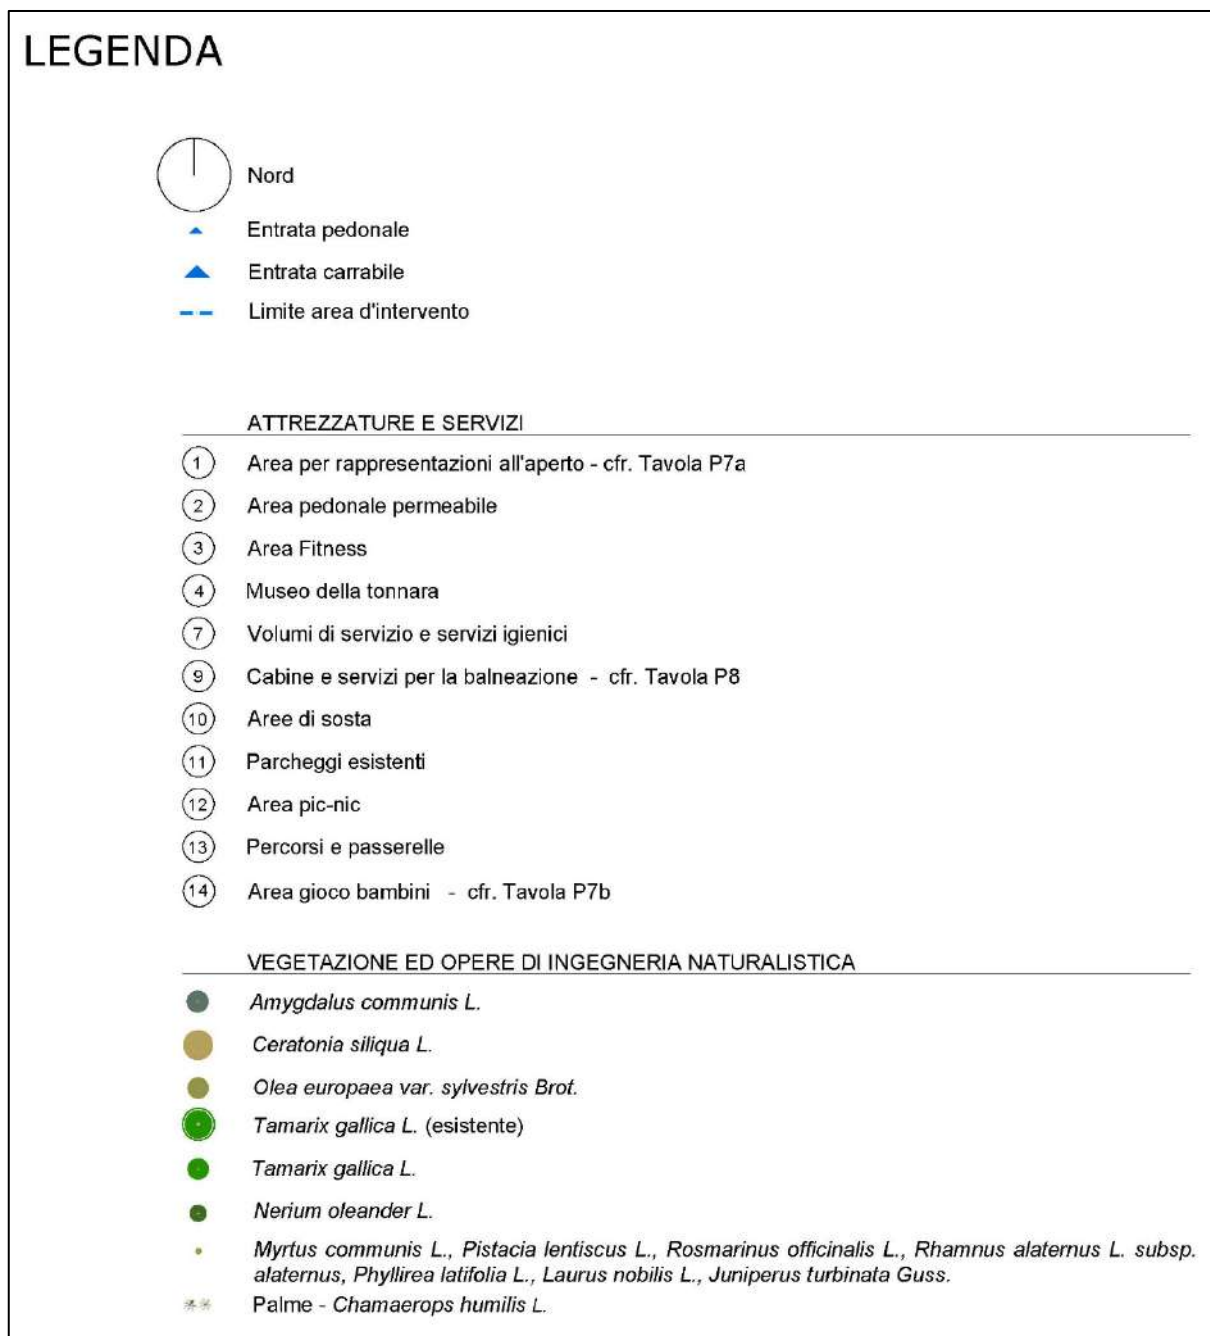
Legenda della planimetria di progetto del Parco Urbano.
